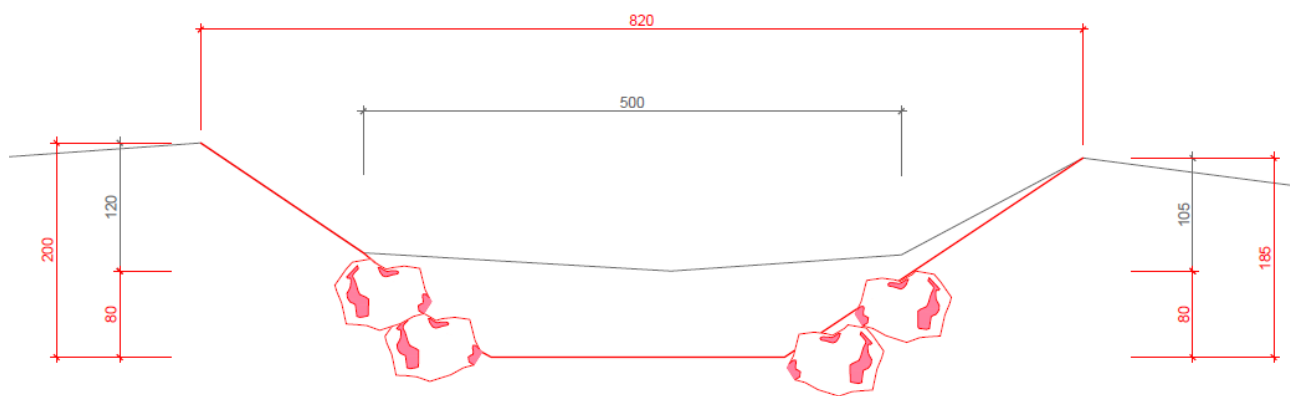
Principe d'approfondissement du lit de 80 cm pour un profil avec berges – coupe-type PK 2.250
